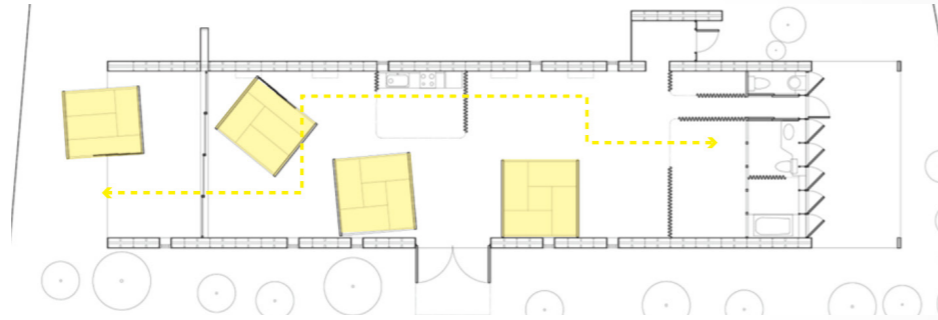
, Planta baja, naked house, Shigeru Ban, 2000.
